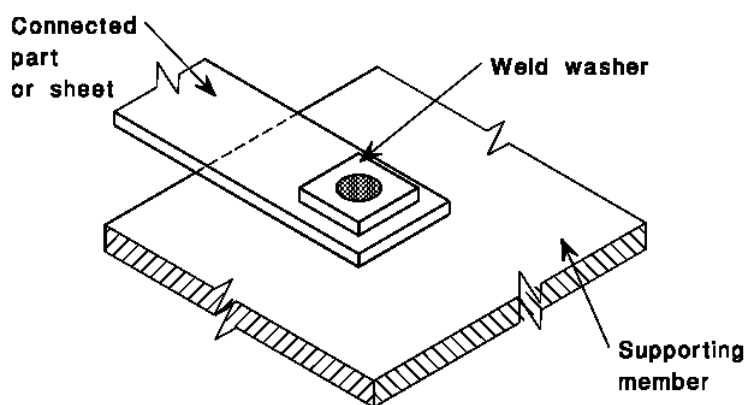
Дуговая точечная сварка со сварной шайбой
